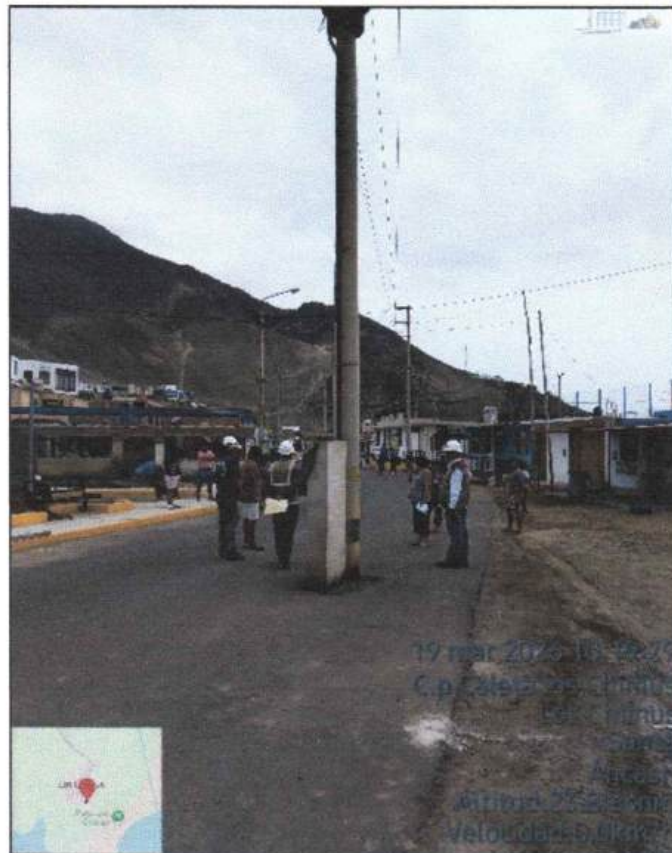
y N°18: Se observa fisura en vista lateral en zona rampa.
